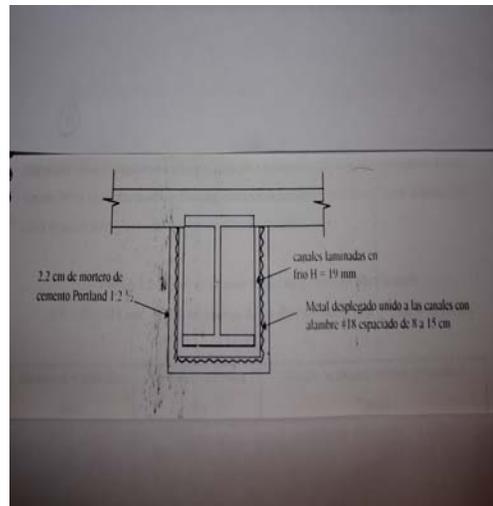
Protección de viga de acero por mortero de cemento (F60).
